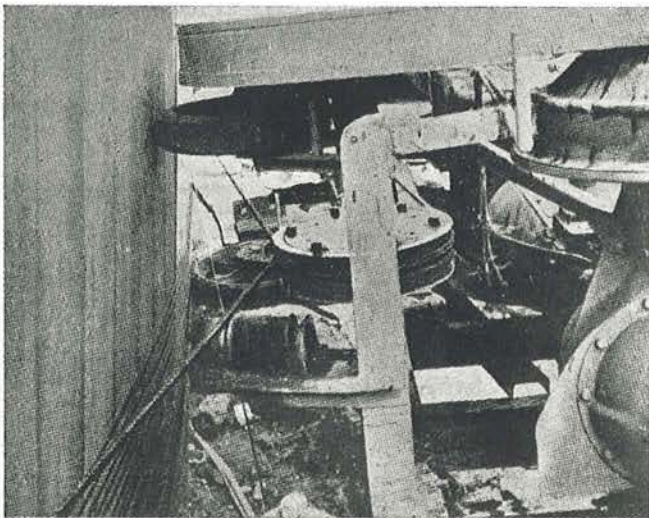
Detalle del dispositivo de arrollamiento del cable.
